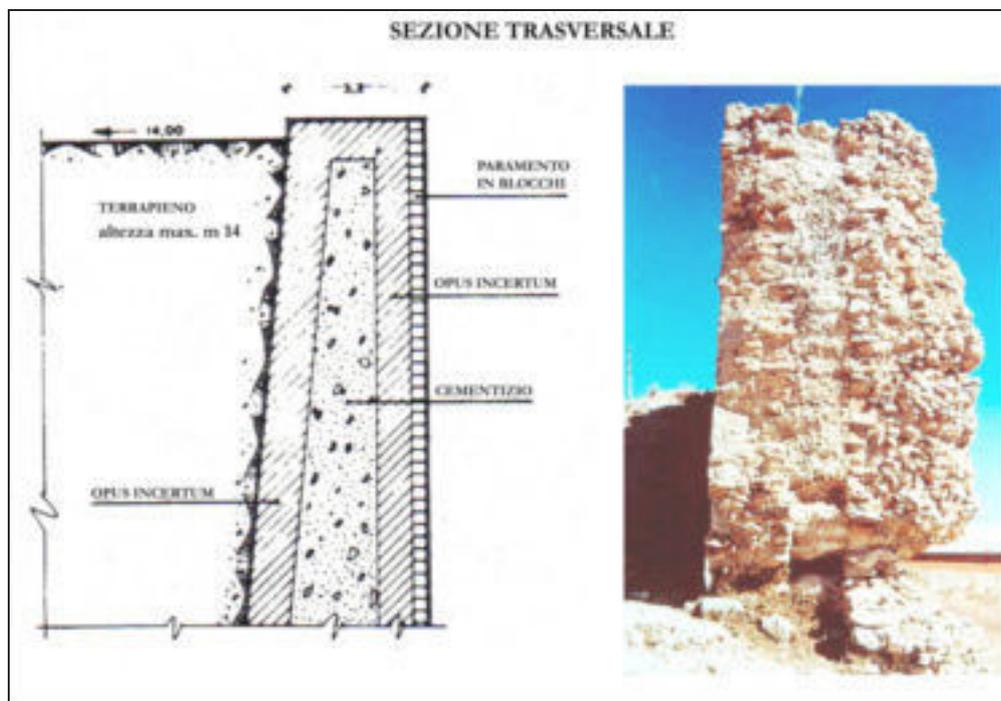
Sezione trasversale del corpo della diga di Alcantarilla, Spagna (CASADO 1983, p. 130).
